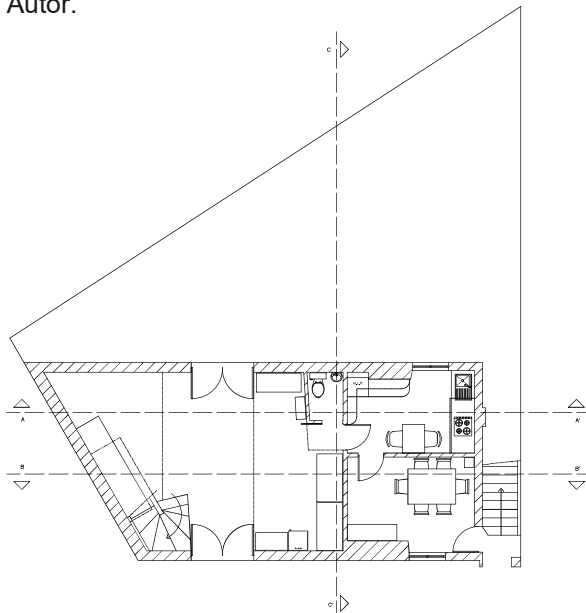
Planta Piso 0, atual. Fonte: Autor.
